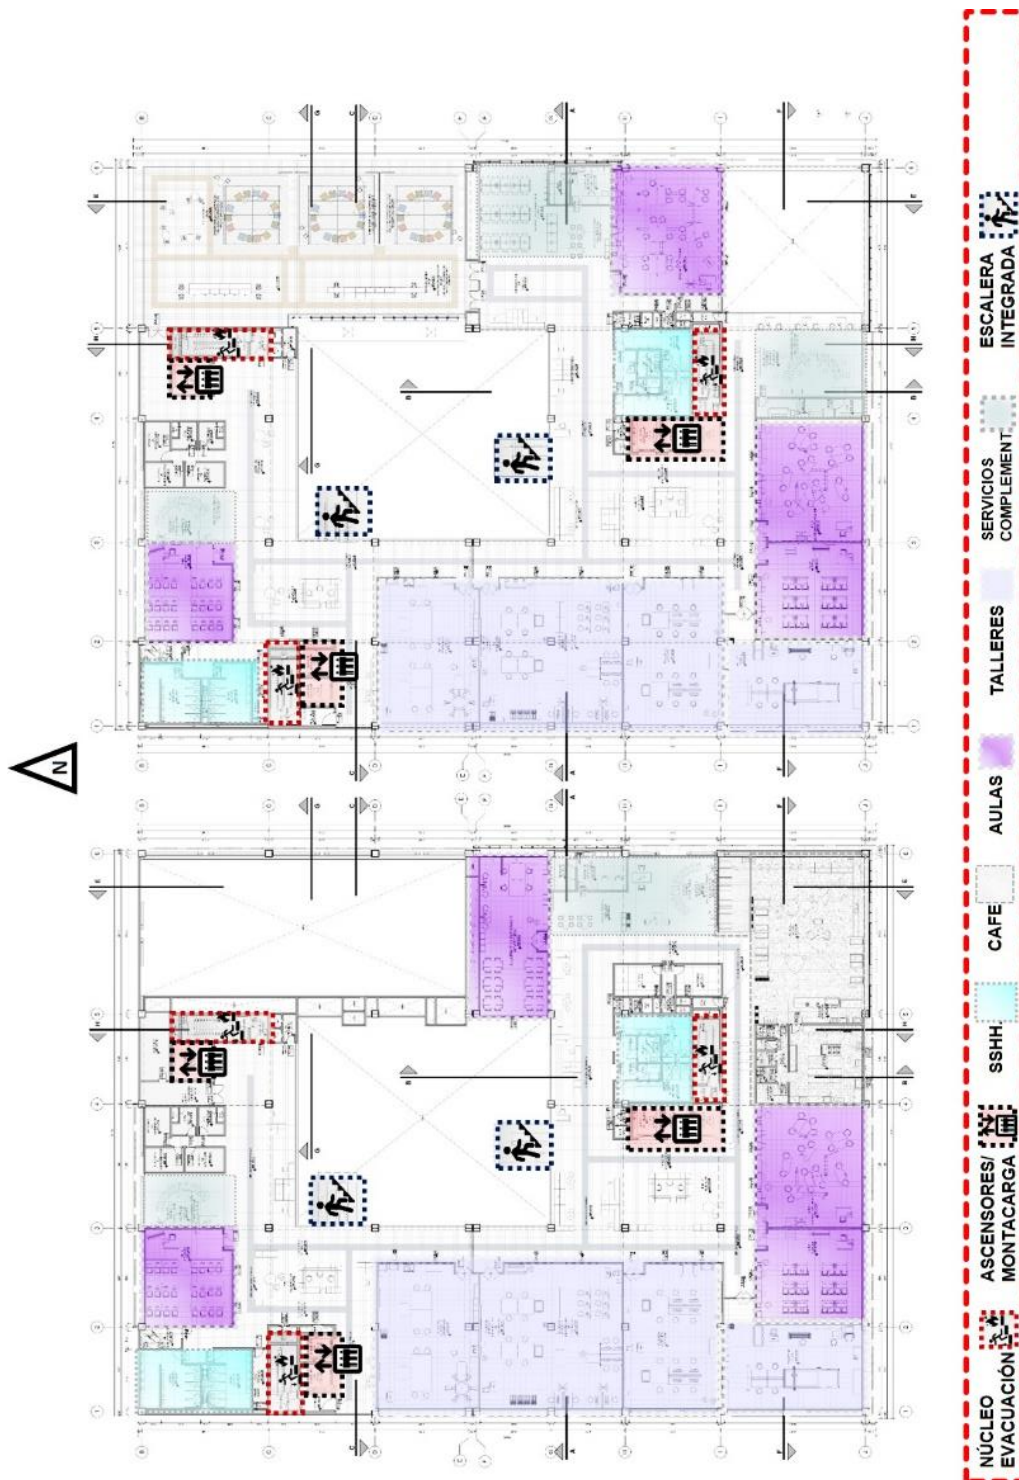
Vistas de las plantas generales del sexto piso (inferior) y del séptimo piso (superior).
